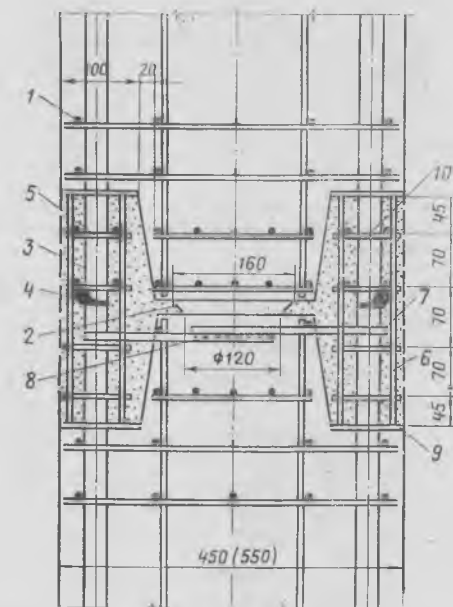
Стык на ванной сварке выпусков арматуры с бетонным центрирующим выступом
